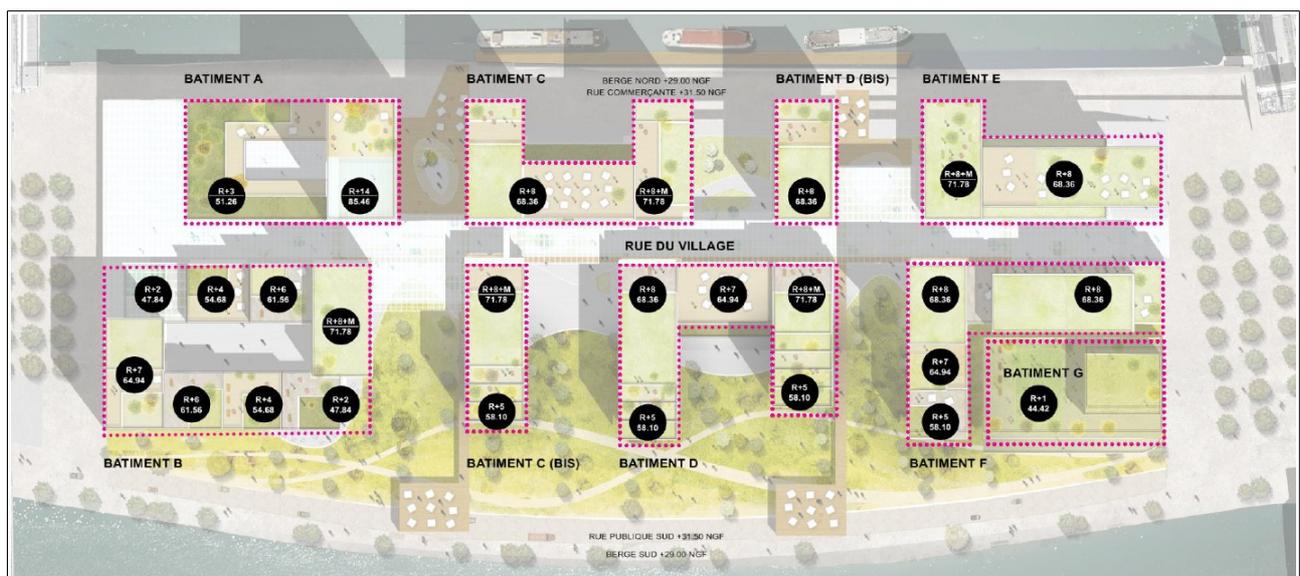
plan d'implantation et d'élévation des bâtiments – source : étude d'impact
